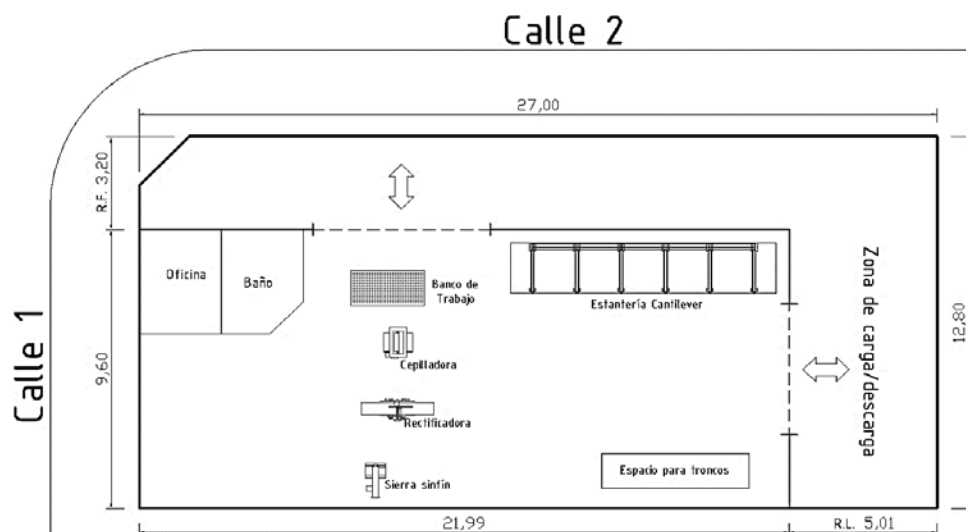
Distribución en planta propuesta en el área edificable (elaboración propia).
